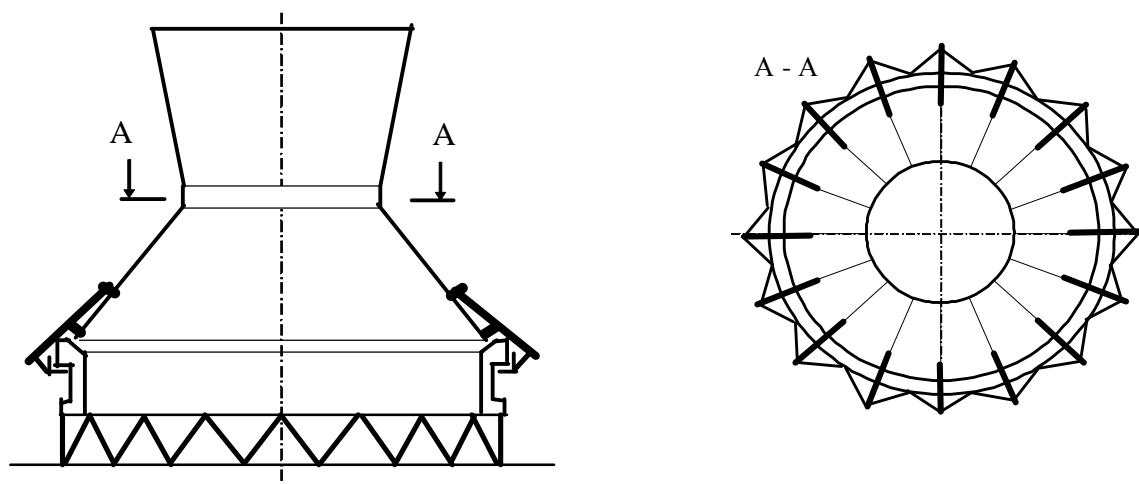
Схема усиления вентиляторной градирни СК-1200 в области опоры конфузора на верхнее железобетонное кольцо
